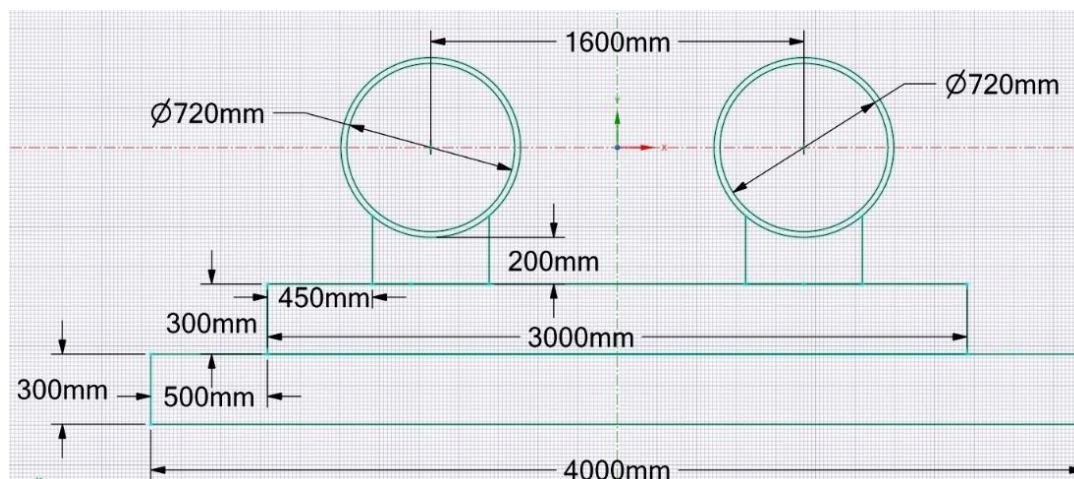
Размеры и габариты 3D-геометрии трубопроводов тепловой сети при надземной прокладке на низких опорах
